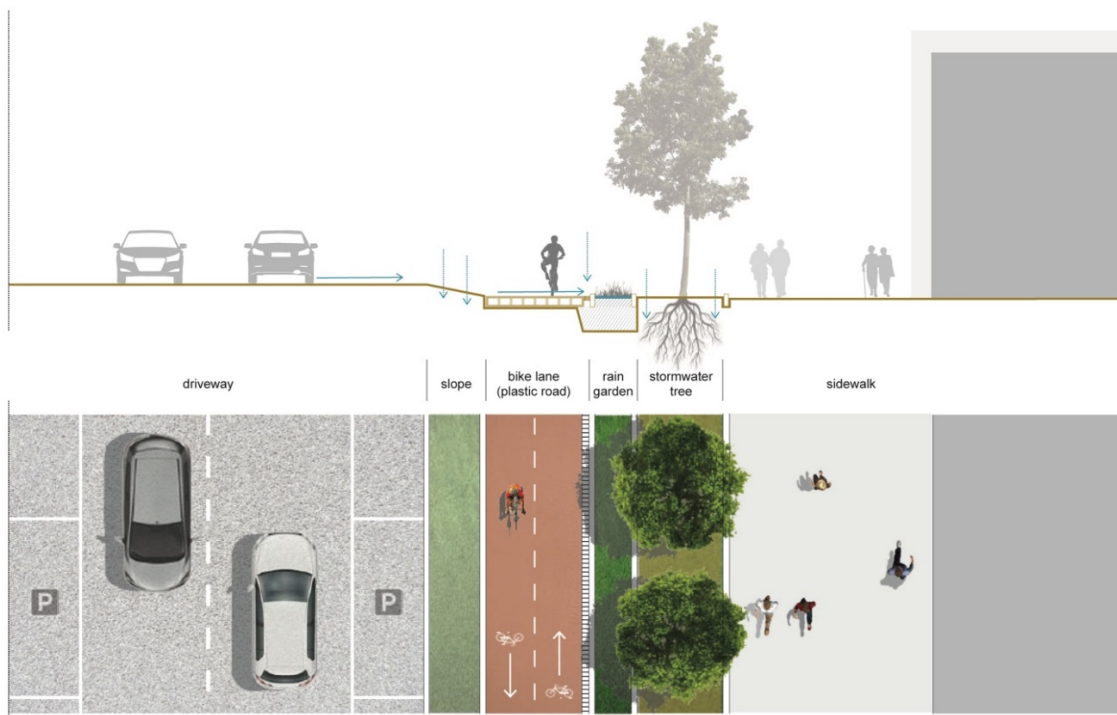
| Zwolle, sezione e planimetria della Plastic Road in Deventerstraatweg.
